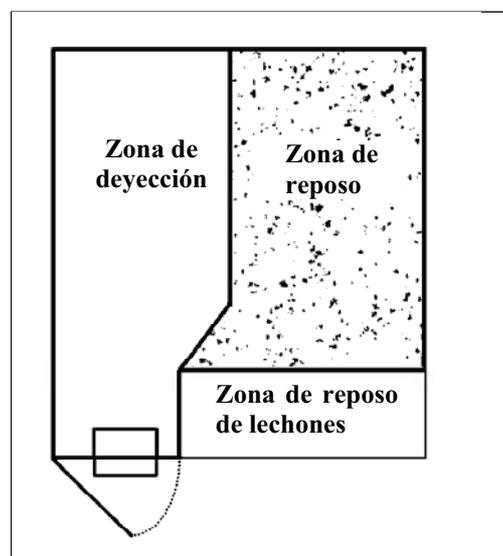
Ejemplo de un plan aplicado para una paridera (suelo parcialmente enrejado) sin restricción de movimiento [31, EAAP, 1998]
